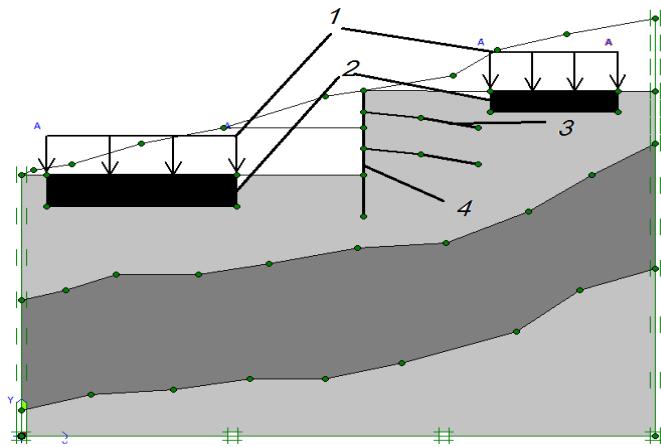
Розрахункова схема із фундаментами запроектованих споруд (2) та навантаженнями (1) від власної ваги на прикладі шпунтової (4) заанкереної (3) підпірної стінки(варіант а+б)
